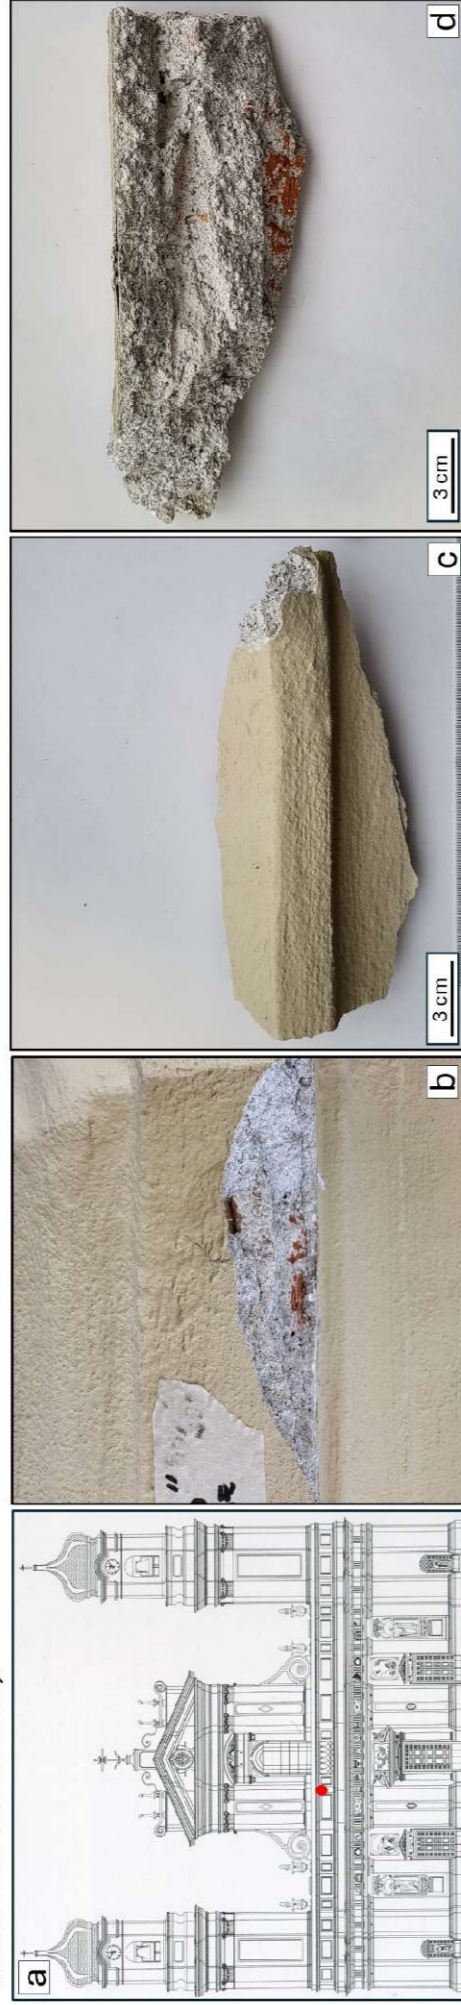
a) posizione campione nel prospetto principale della Basilica; b) punto di prelievo del campione 7; c) campione C7 (vista dall'alto); d) campione C7 (vista dal basso).
